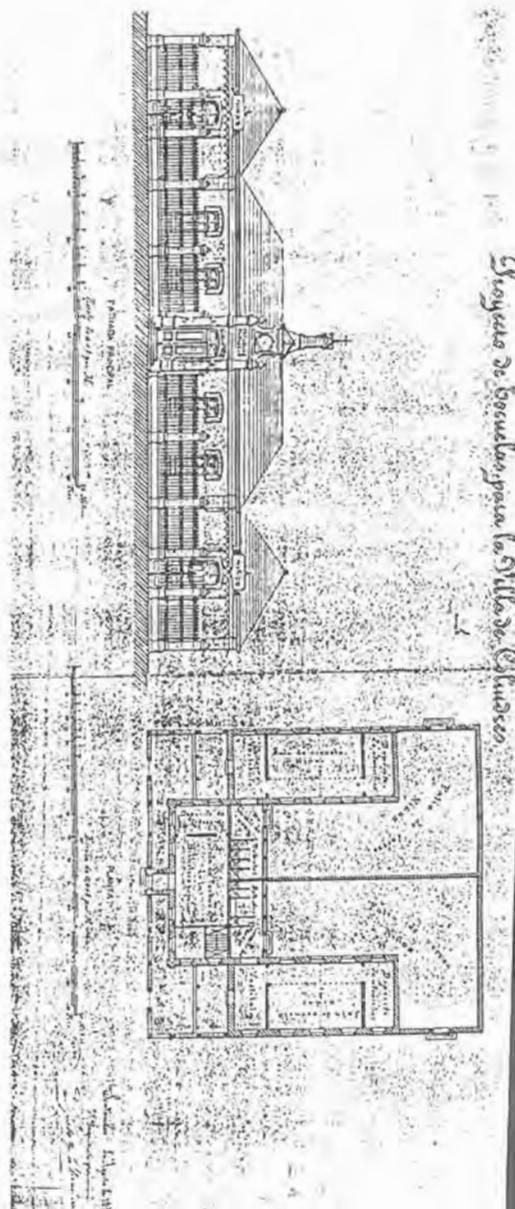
Segundo proyecto para las Escuelas. Fachada principal y planta.
